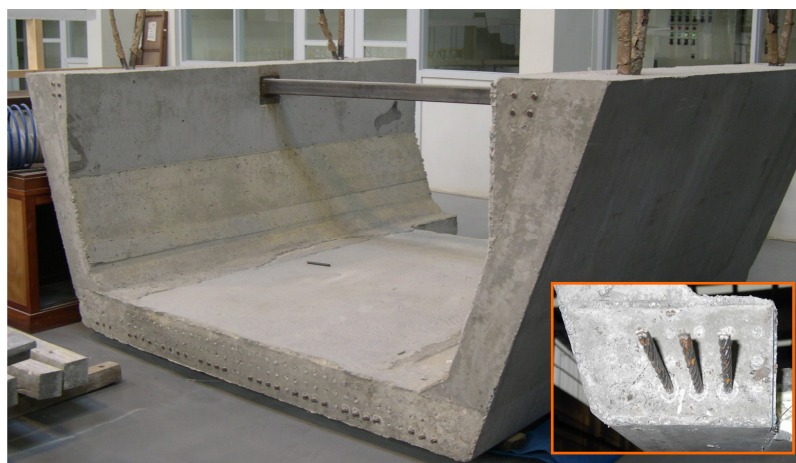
Aspecto da viga-caixão depois da descofragem
